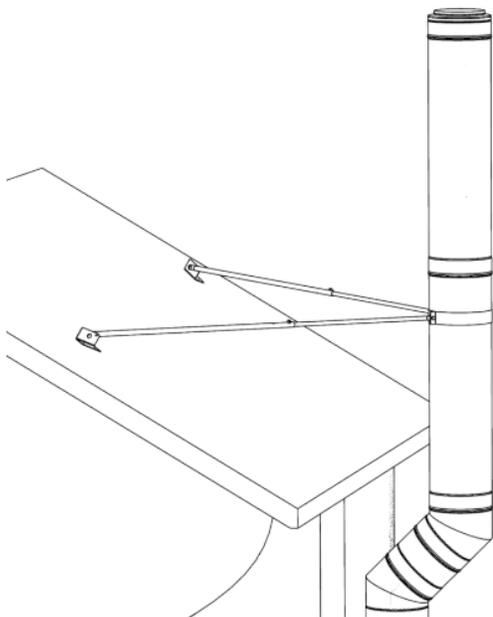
, Fascetta stabilizzante sopra tetto (191)
